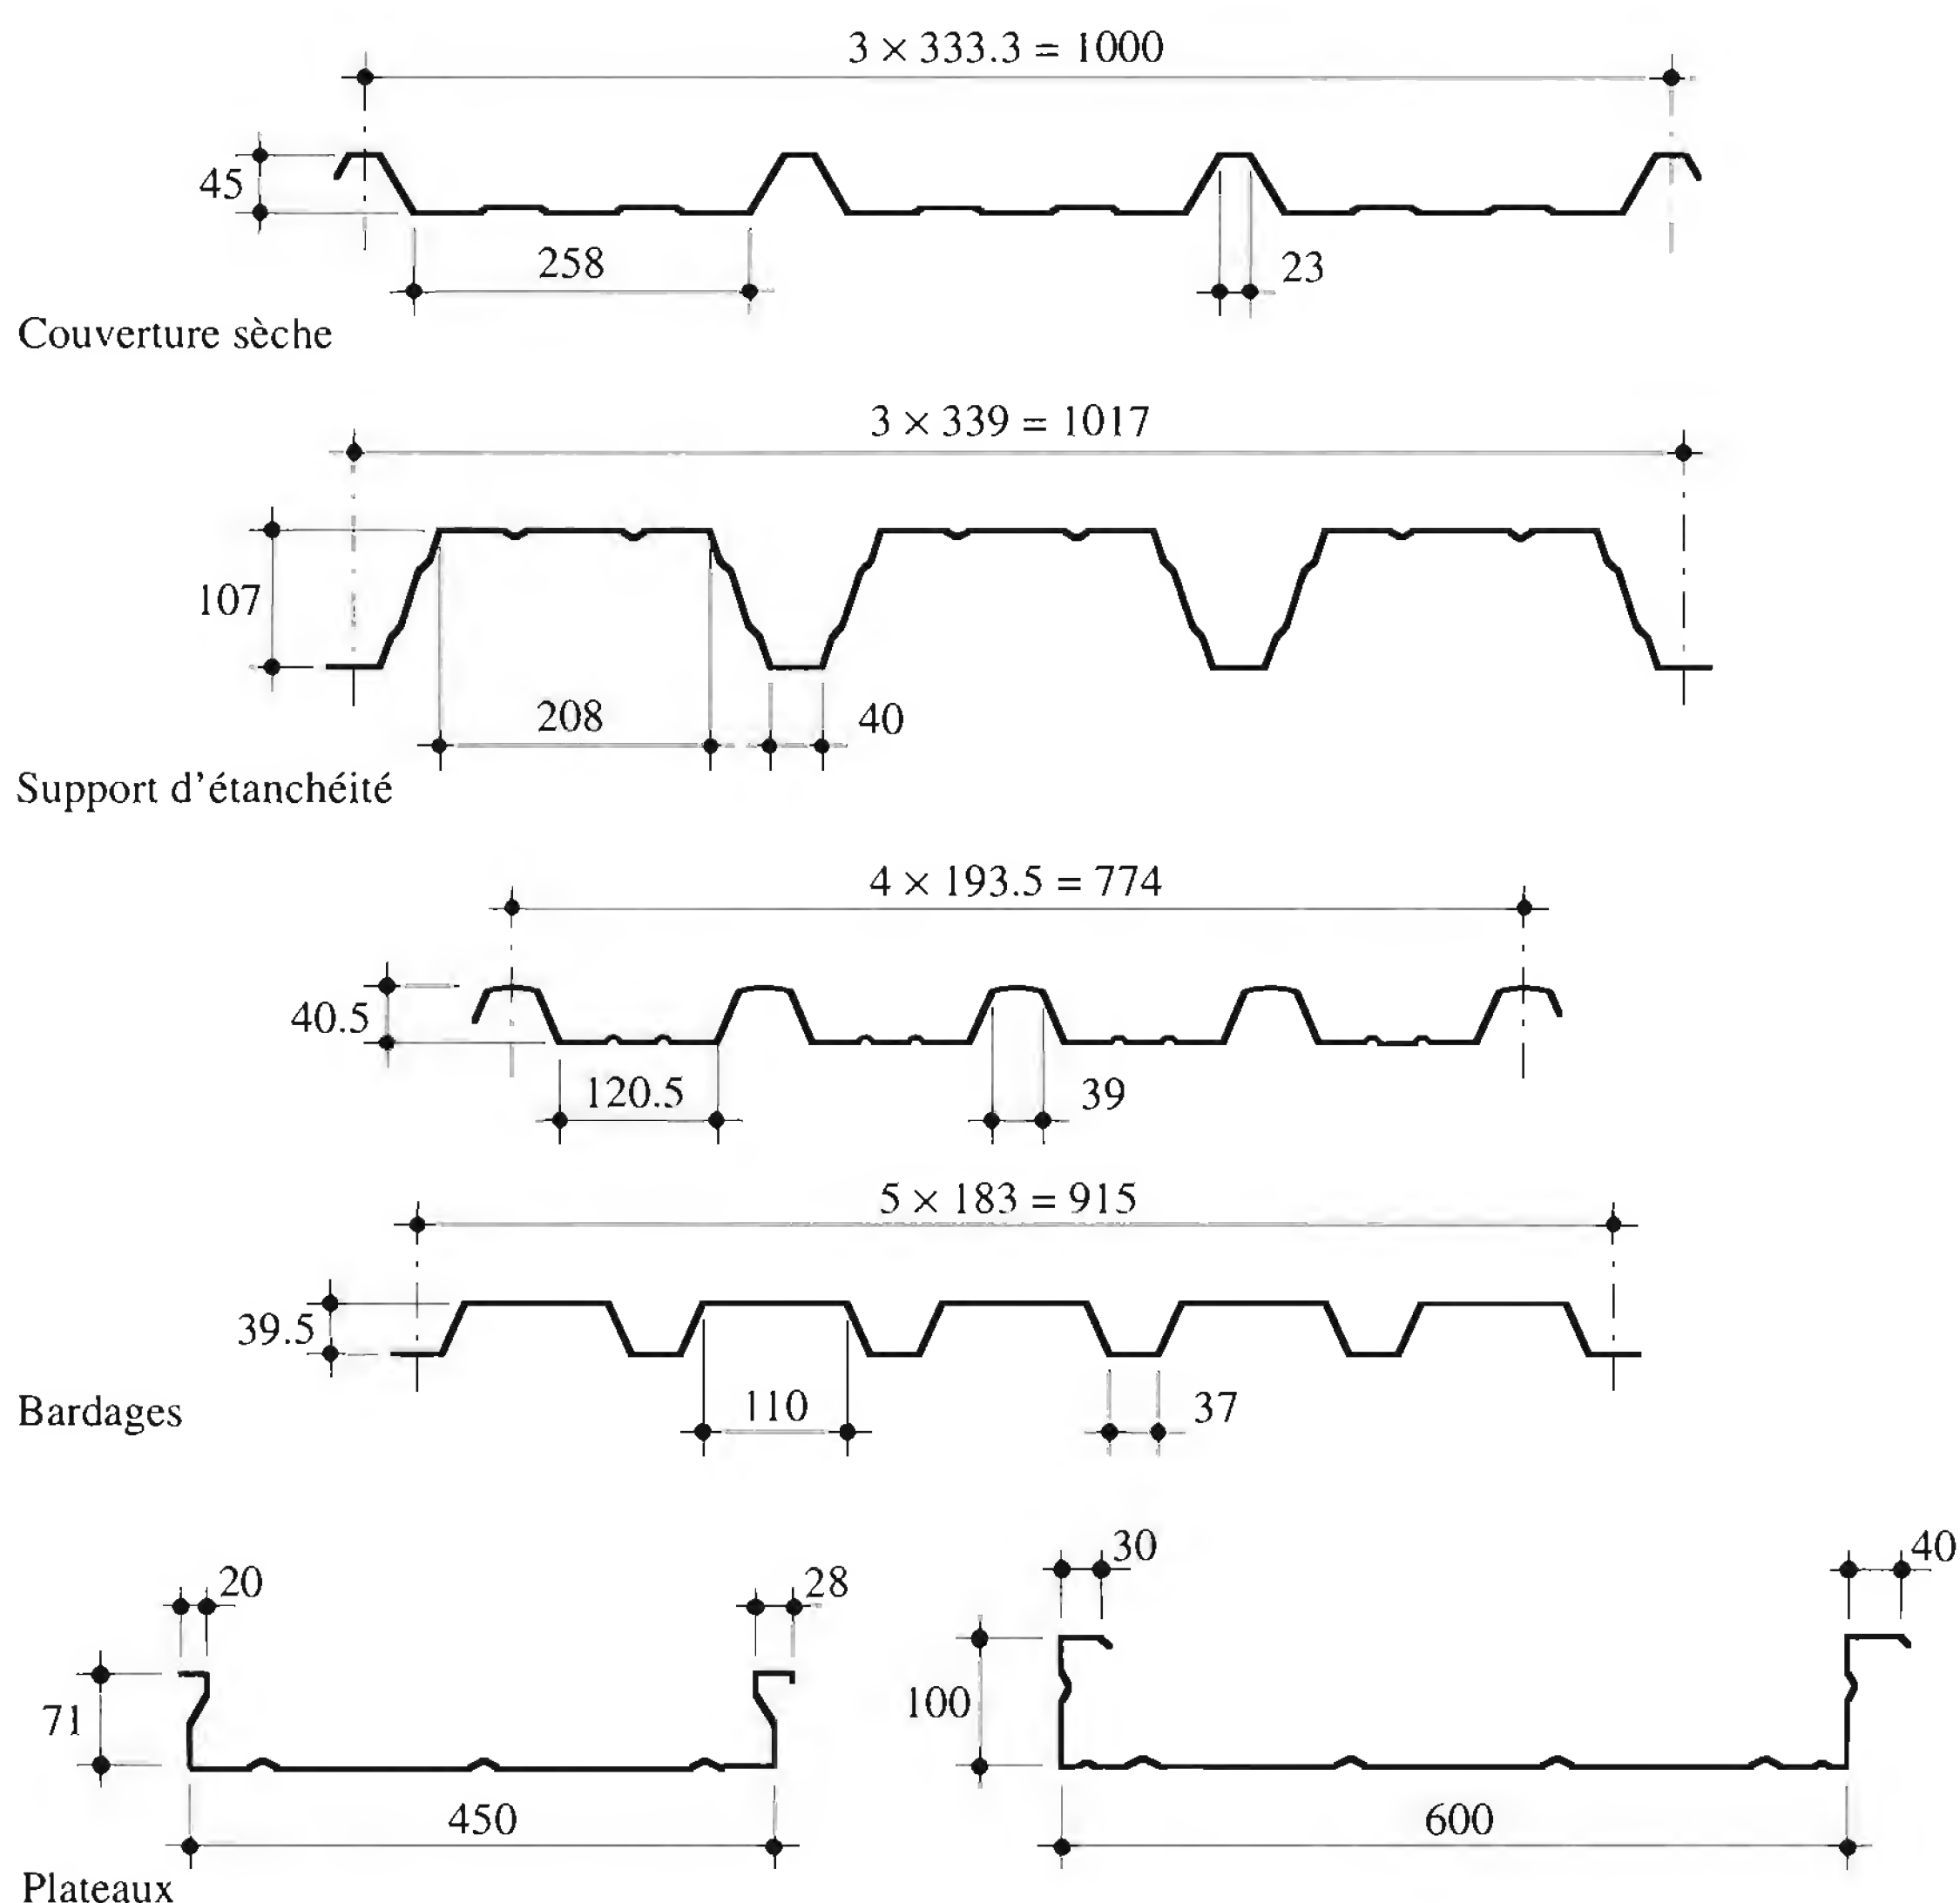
Exemples de tôles profilées à froid pour plaques et panneaux de toiture et façade.
